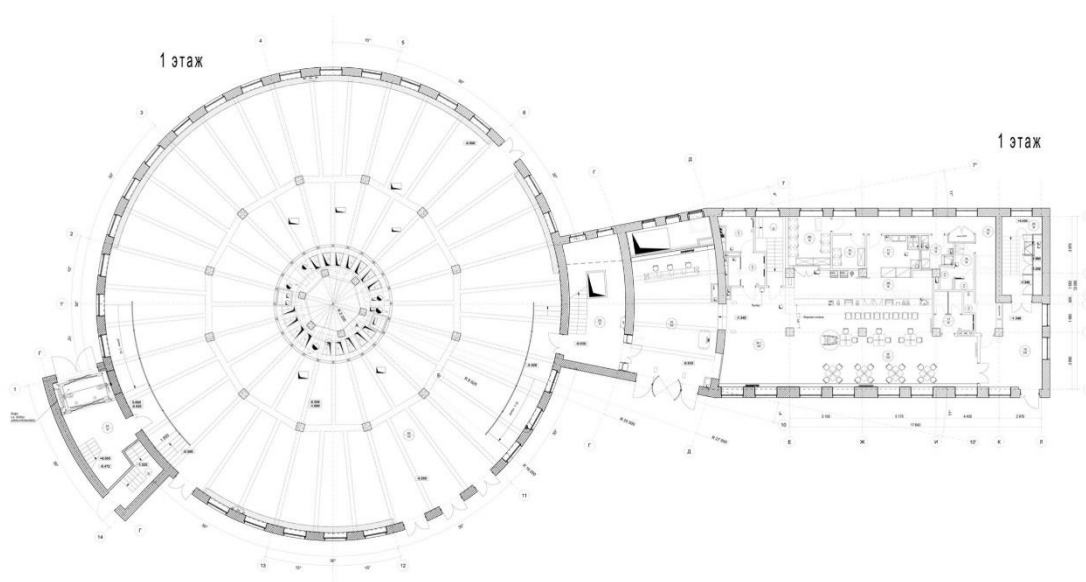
План 1-го этажа Хлебозавода №5 после реконструкции
